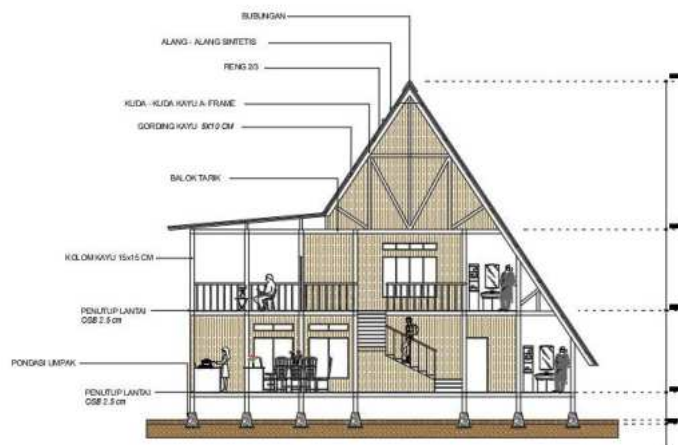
23 Konsep Struktur Dan Konstruksi Pada Bangunan Villa Tipe 2
